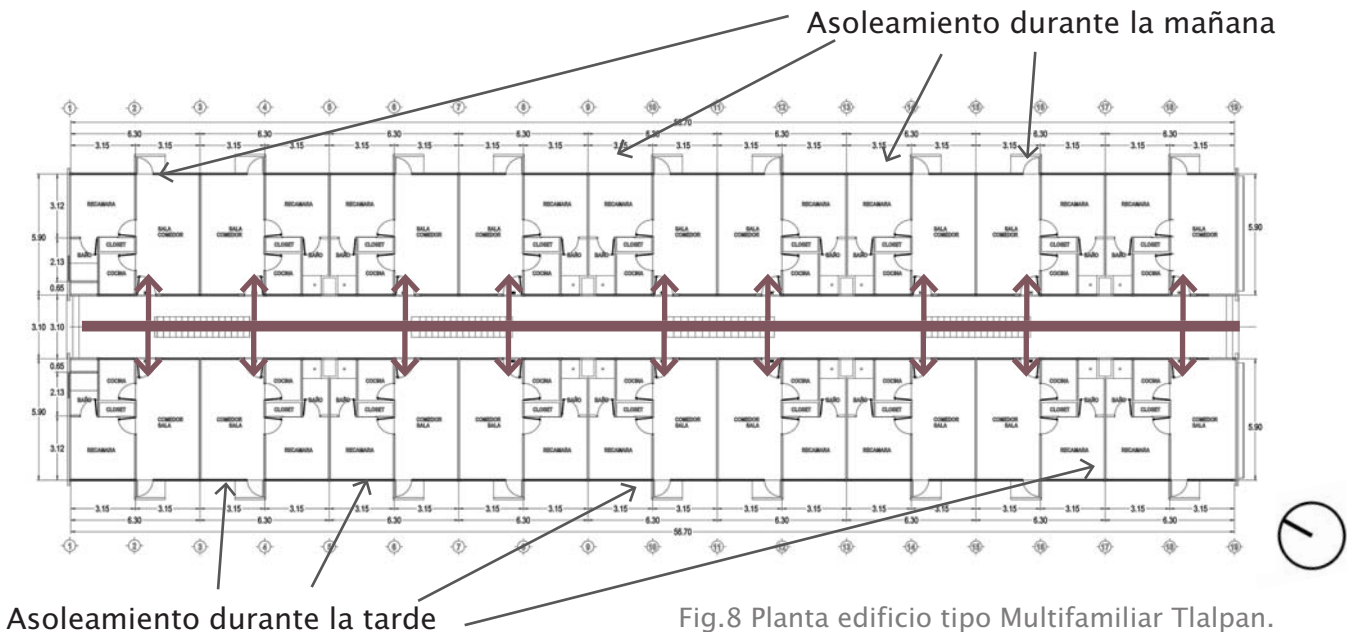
Planta edificio tipo Multifamiliar Tlalpan.
